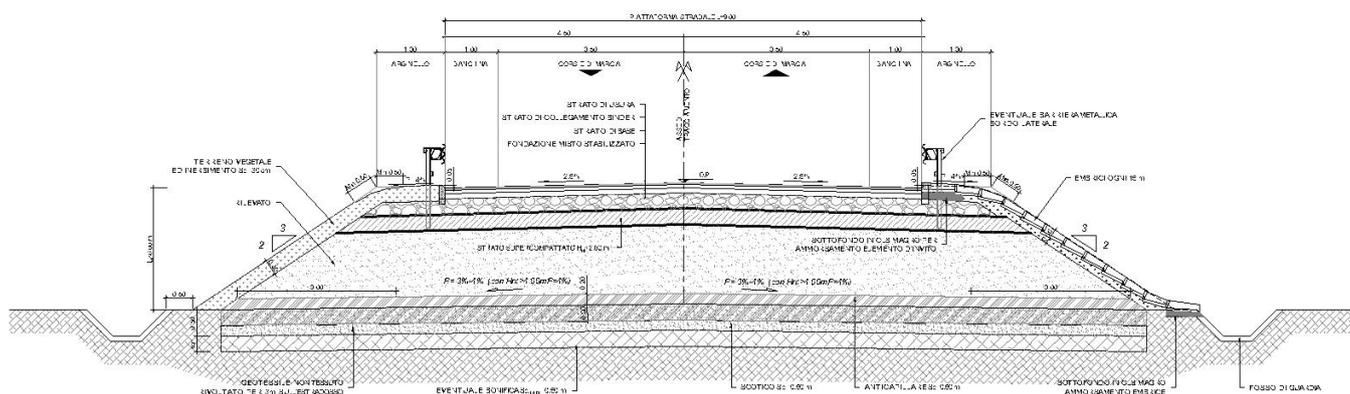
Cat. F1 sezione tipo in rilevato Hril ≤ 6.00 m
